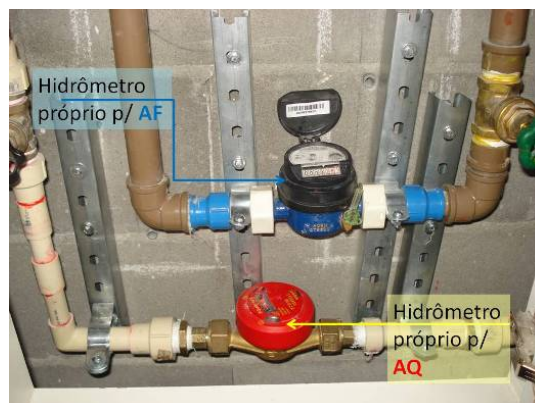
Hidrômetros individuais instalados em cada pavimento tipo, após intervenção.
